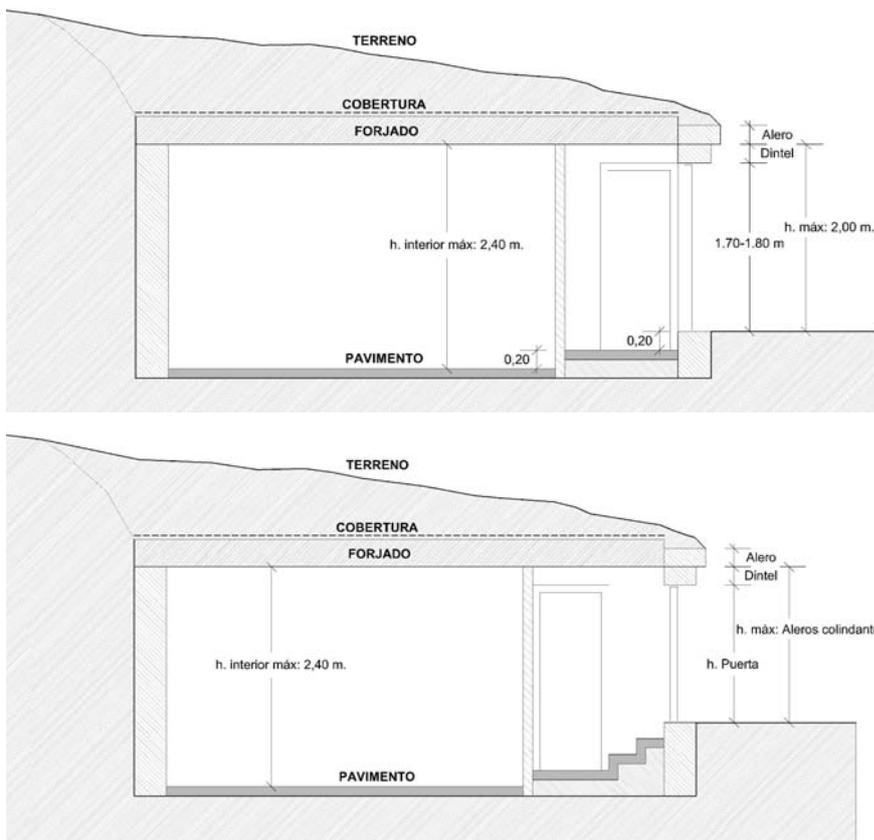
Secciones tipo de merendero de nueva construcción.
